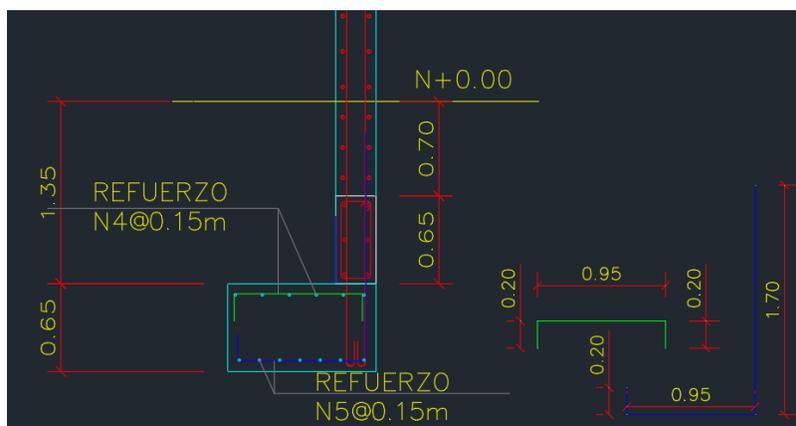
despiece de zapata corrida (fuente: planos estructurales Edificio Fourvière)
